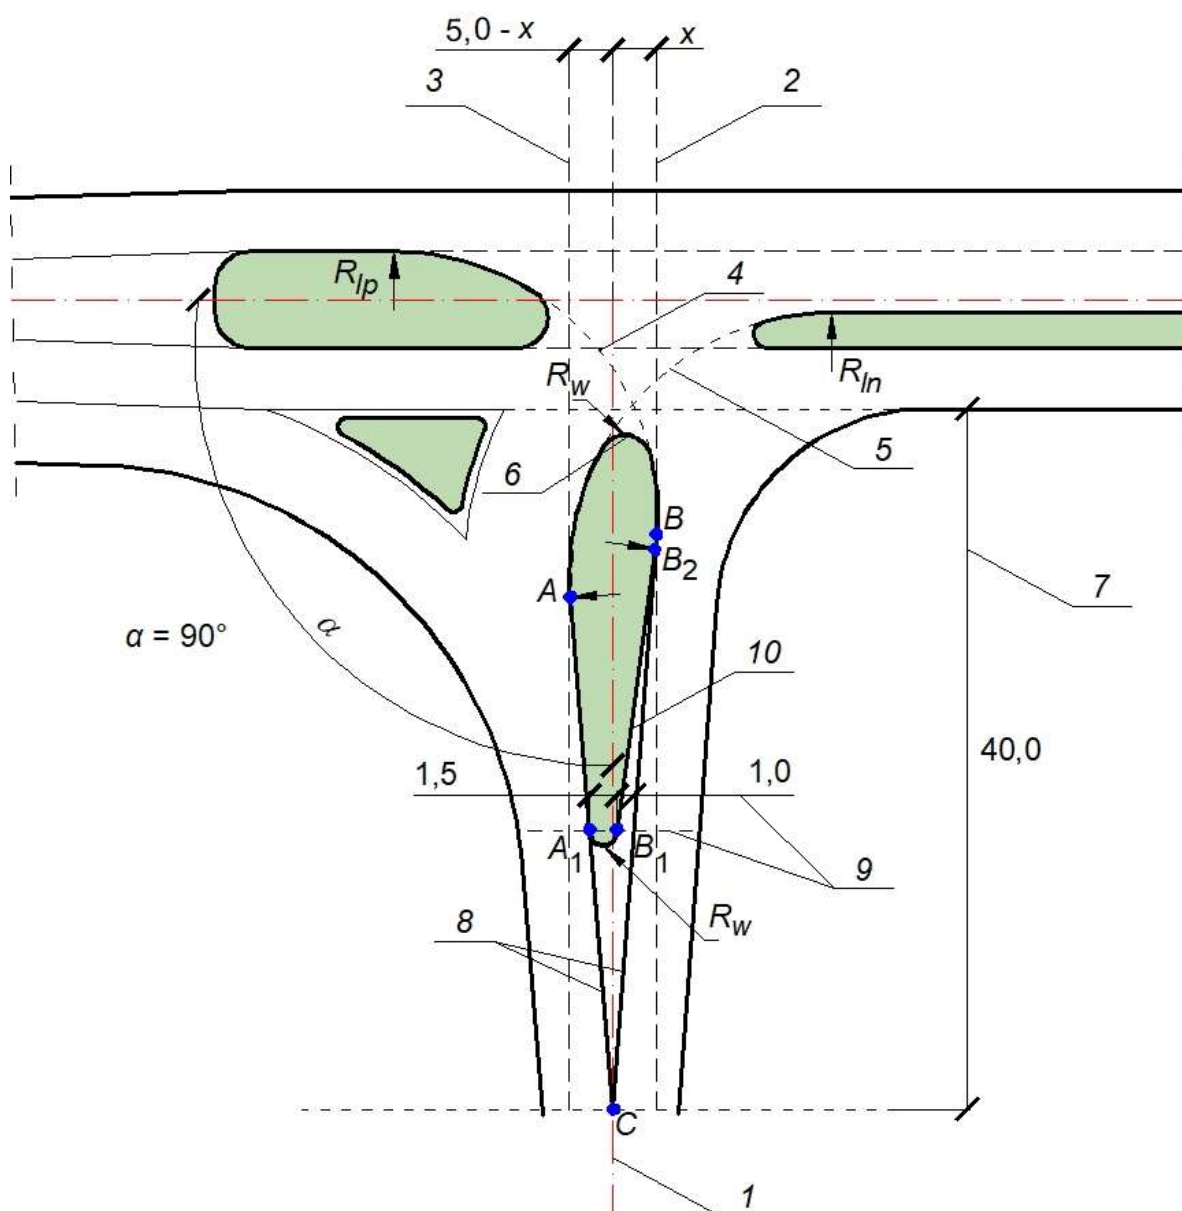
Konstrukcja wyspy typu „mała kropla”
